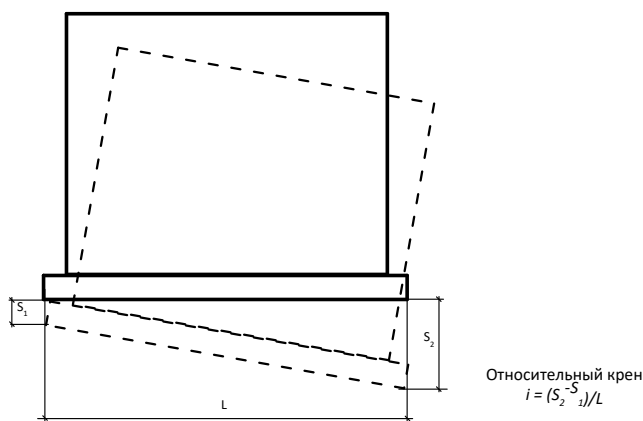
Схема крена фундамента жесткого сооружения
